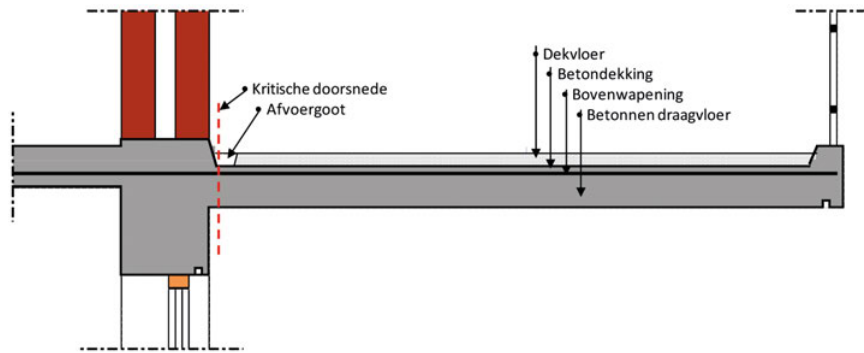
Schematische weergave van uitragende betonnen vloeren. Overgenomen uit *CUR 248: Onderzoek naar en beoordeling van de constructieve veiligheid van uitragende betonnen vloeren van galerijflats* (p. 11) door F. Jonker, M. De Jonker, D.G. Mans en S.N.M. Wijte, 2014, Rotterdam: SBRCURnet en Platform Constructieve Veiligheid. Copyright 2014, SBRCURnet en Platform Constructieve Veiligheid.
